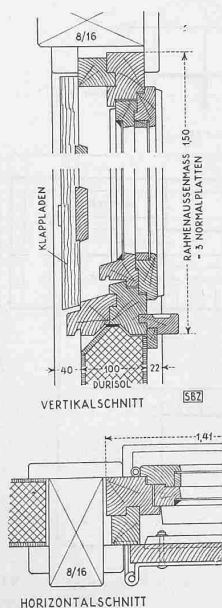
Fensterdetail 1:10; Plattendetail 1:5 und 1:25
